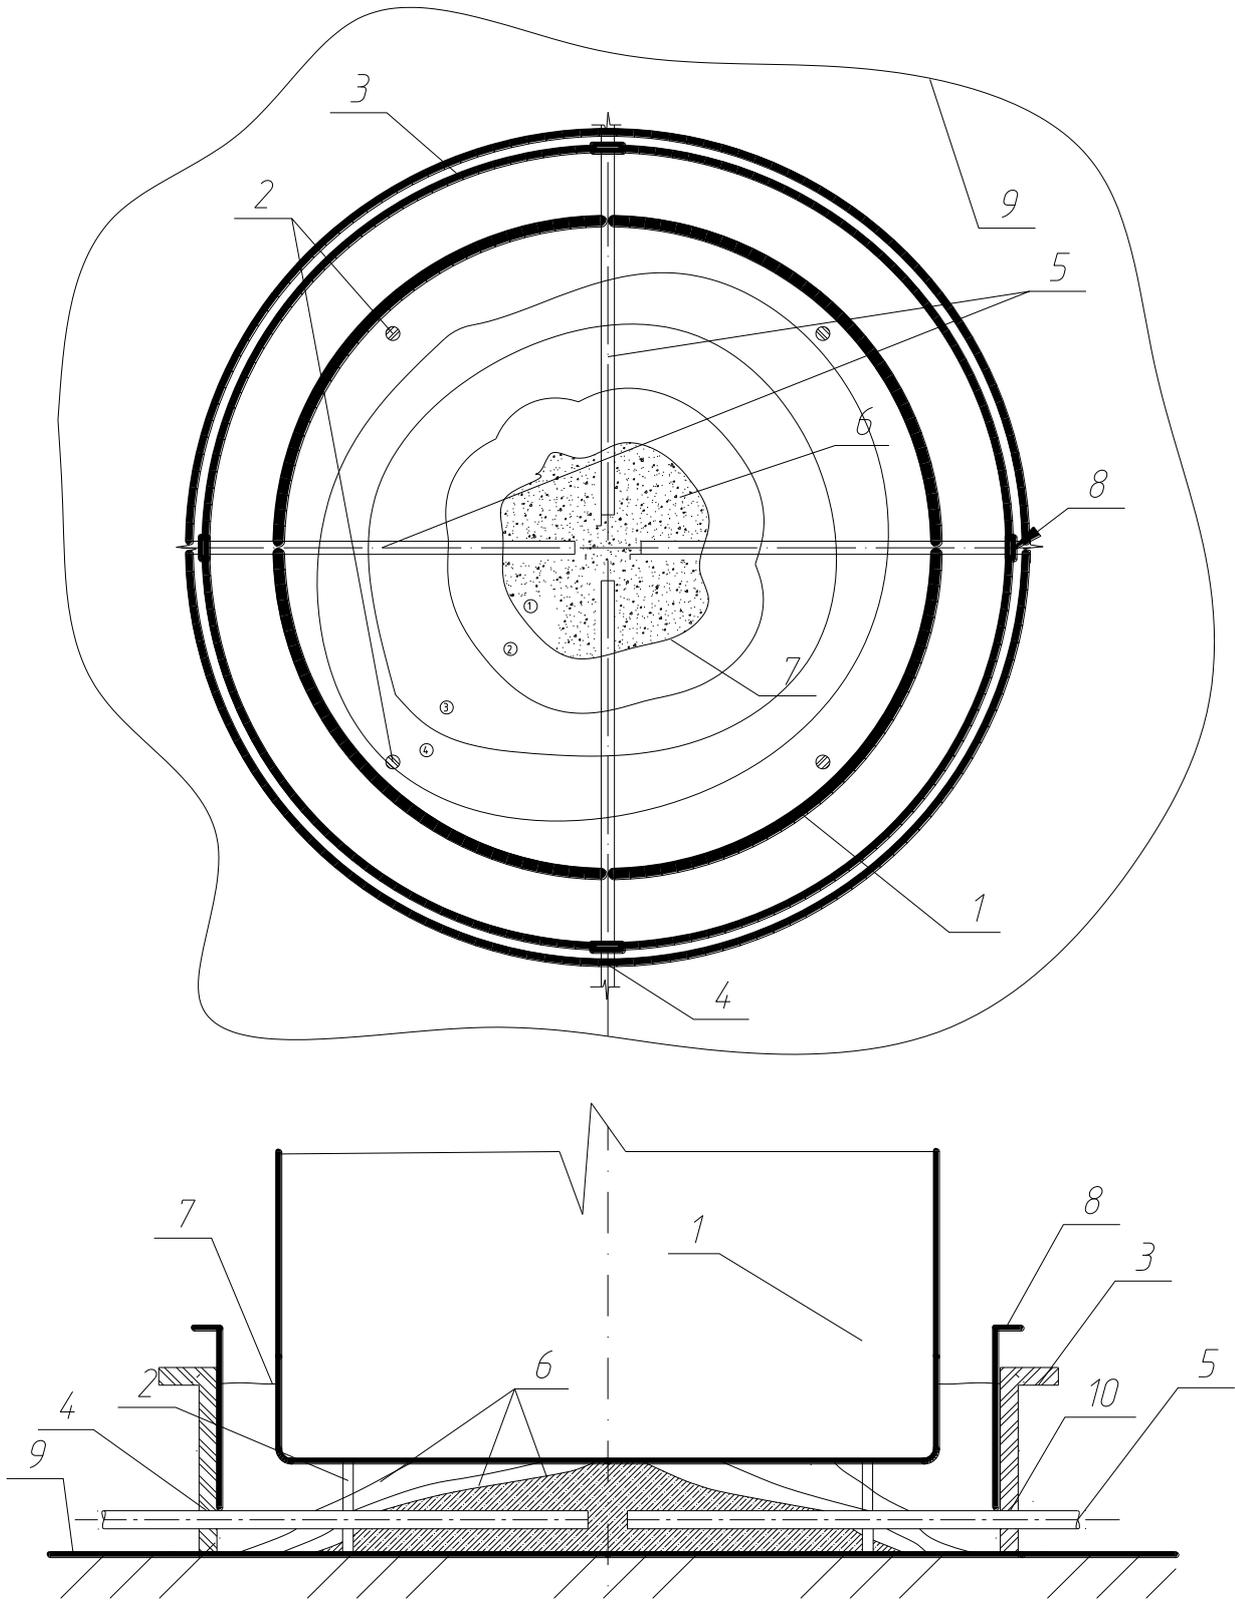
а Схема бетонирования полости из центра нагнетательным методом: 1-оборудование; 2 – опоры; 3 – опалубка; 4 – отверстия в опалубке под бетоноводы; 5 – бетоноводы; 6 – бетонная смесь; 7 – уровень бетонирования (подпора); 8 – заглушки; 9 – основание; 10 – уплотнитель.
